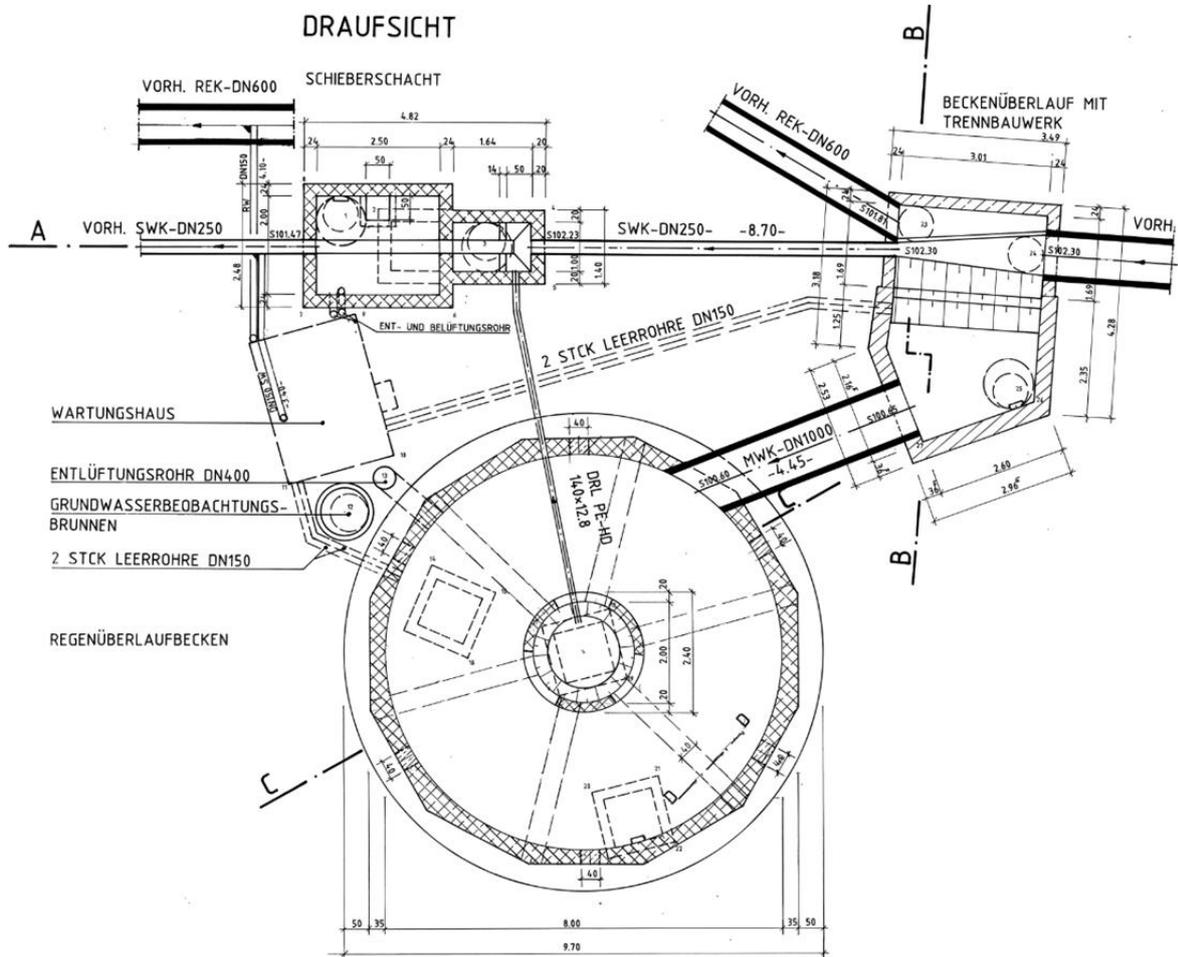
Planungsausschnitt (Grundriss des Bauwerks)
